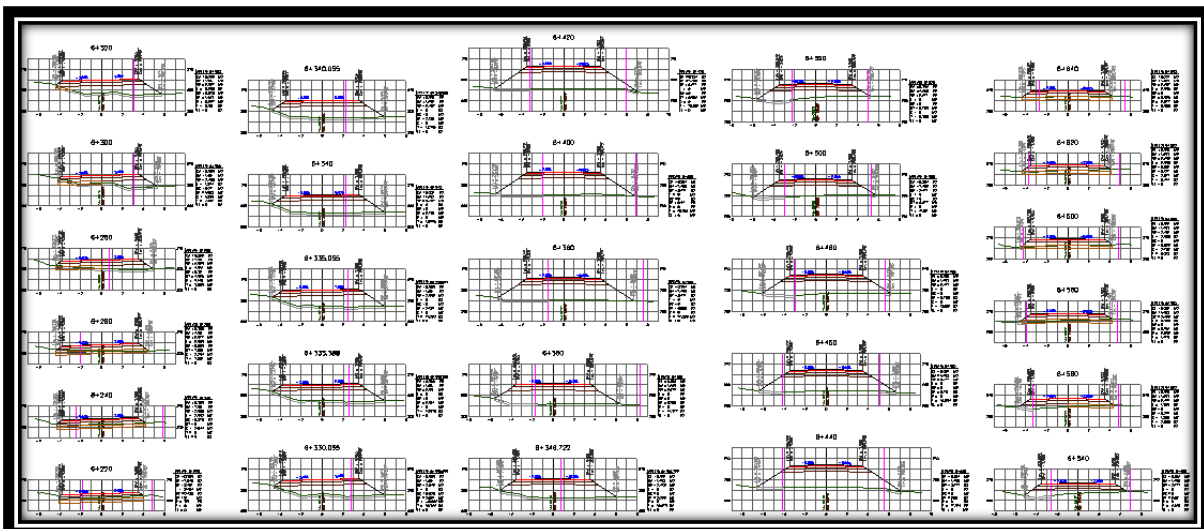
Secciones de construcción del km 6+220.000 al km 6+640.000.
